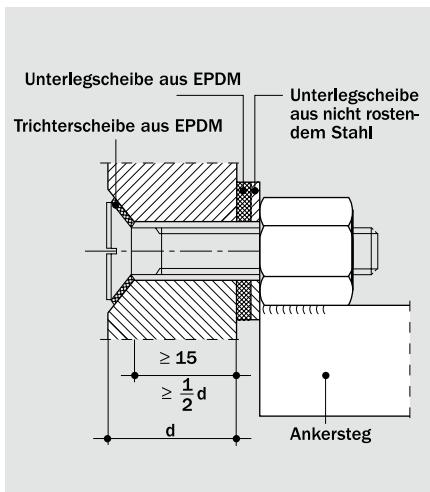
Sichtbare Schraubbefestigung von Naturwerksteinbekleidungen
